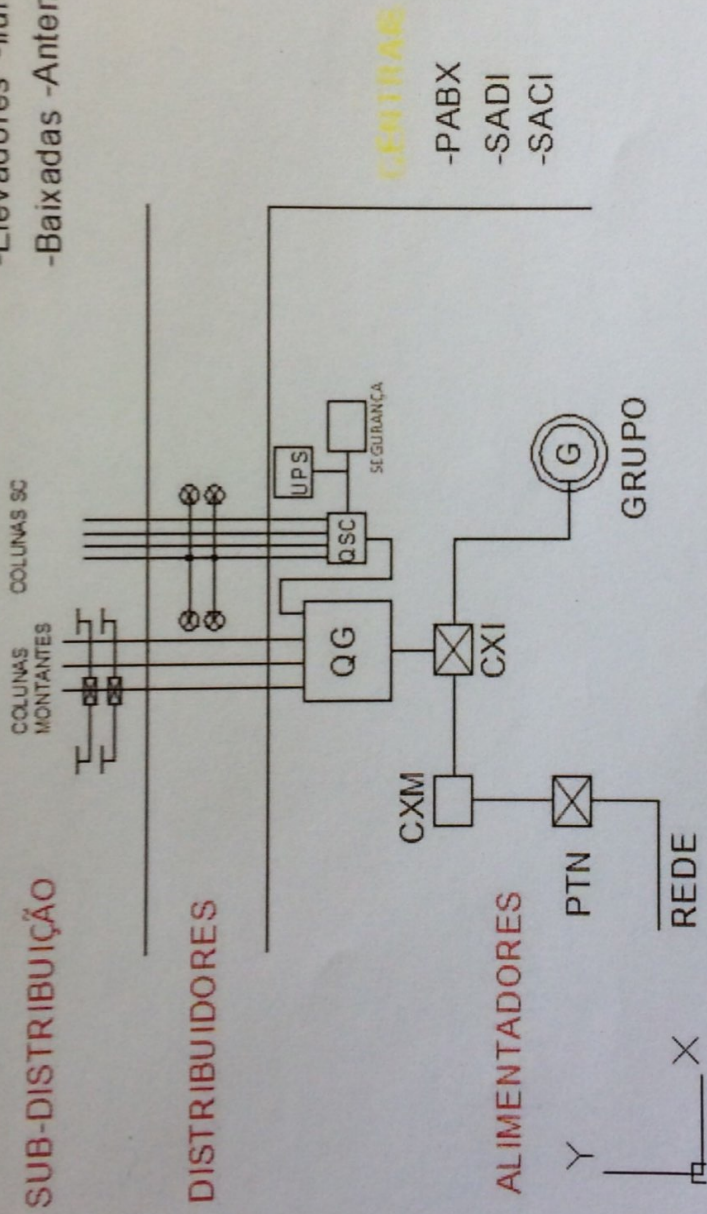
Sistema simplificado de segurança nas edificações (Fonte: Diagrama desenhado do AutoCAD)
